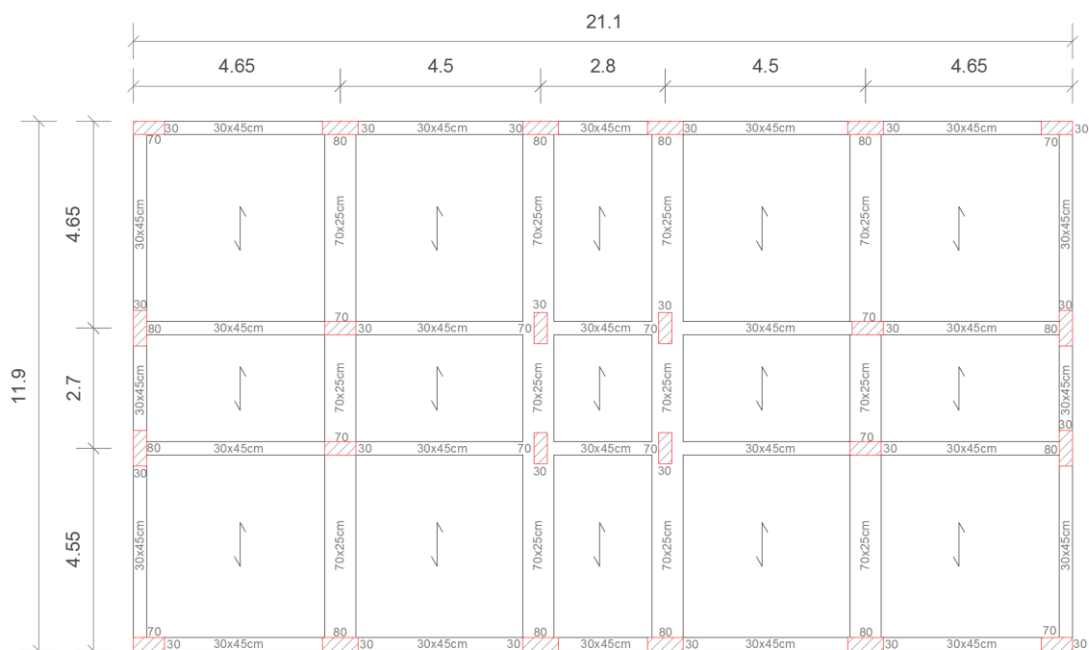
Carpenteria solaio di sottotetto struttura in c.a. a tre piani.
